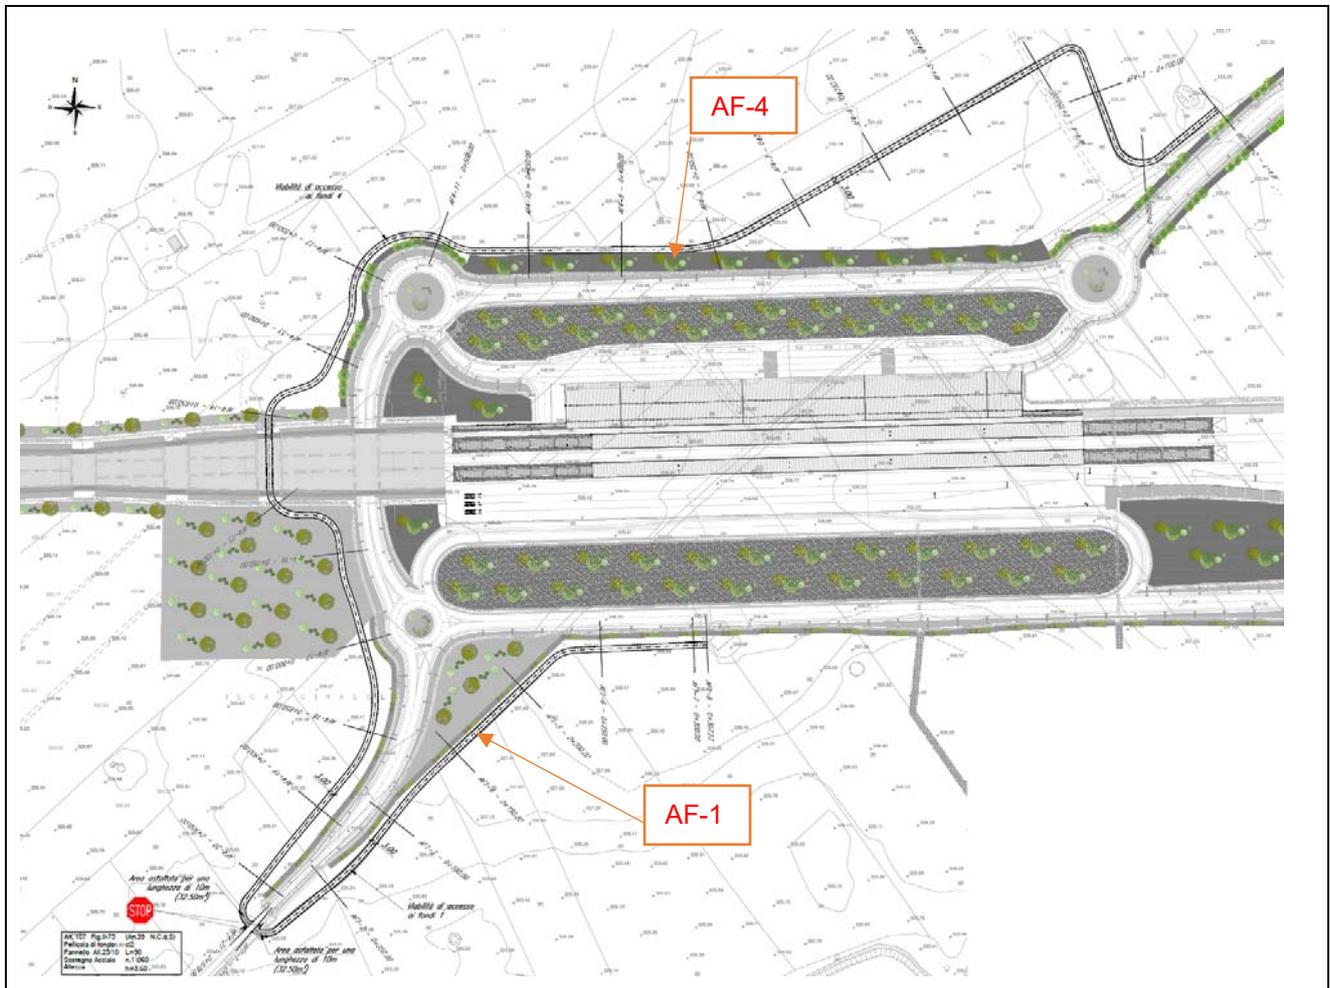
Planimetria delle viabilità di accesso ai fondi – Zona 1 (Sud)
